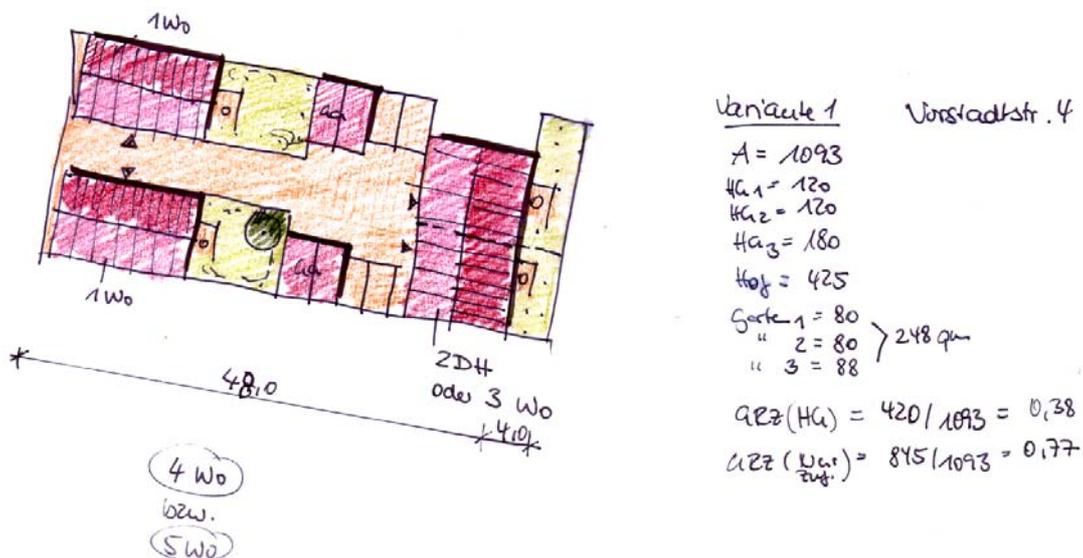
Variante 1 mit möglicher Bebauungsform für das Grundstück Vorstadtstraße 4
